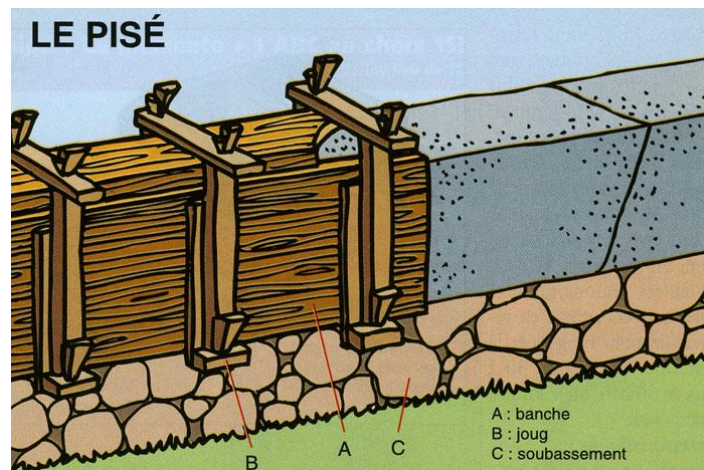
Coffrage utilisé dans la conception d'un mur en pisé.
